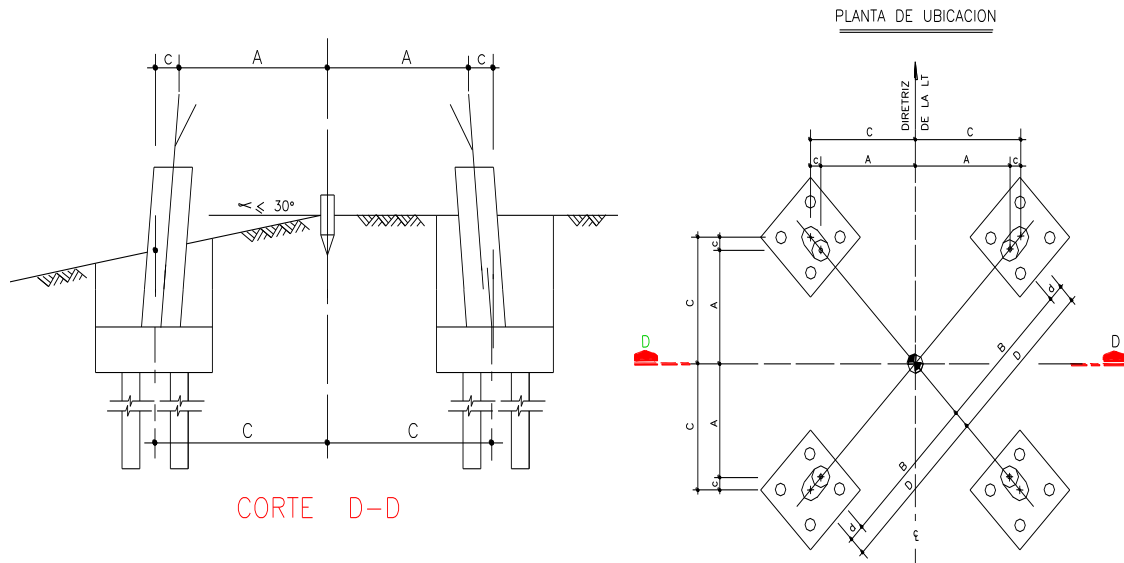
Vista de perfil y de plata de la cimentación de pitotes en una torre de transmisión eléctrica.²¹
